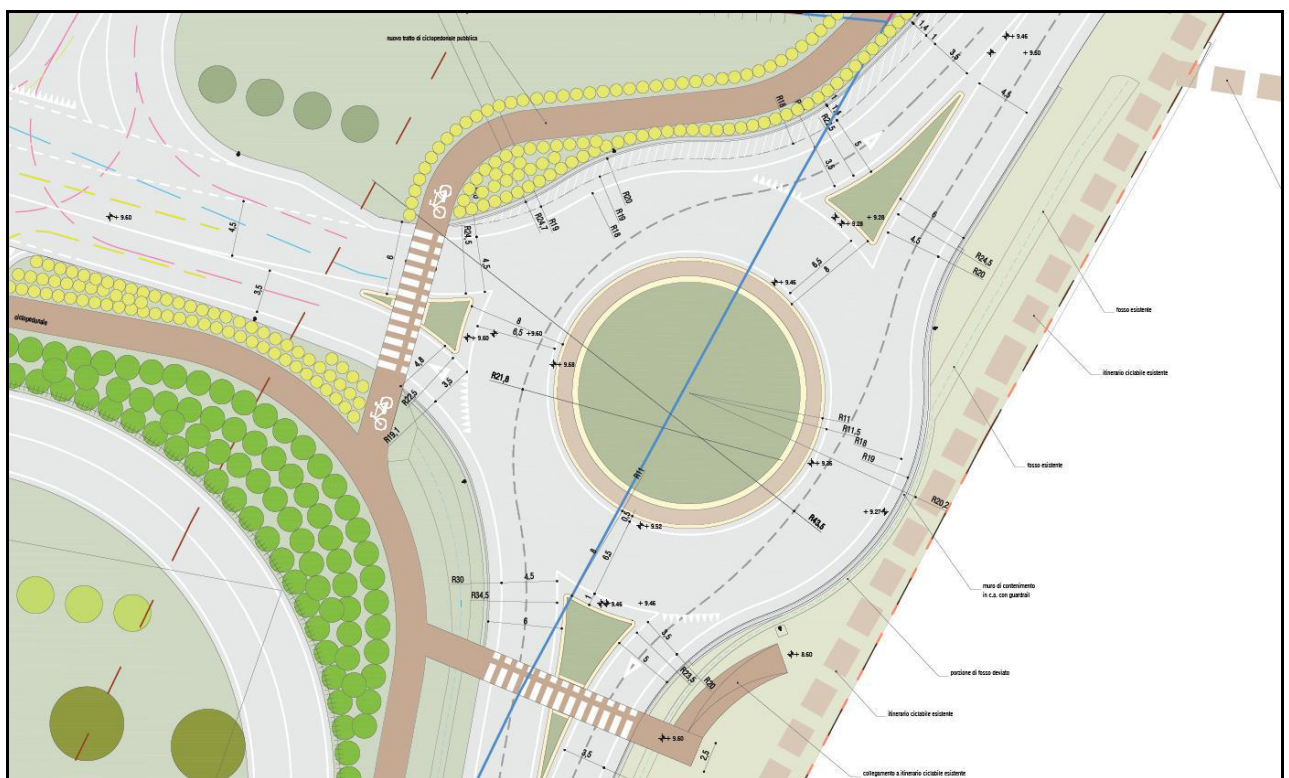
Particolare della rotonda in progetto per l’intersezione tra la S.P. 52 e la strada di accesso all’area di intervento
